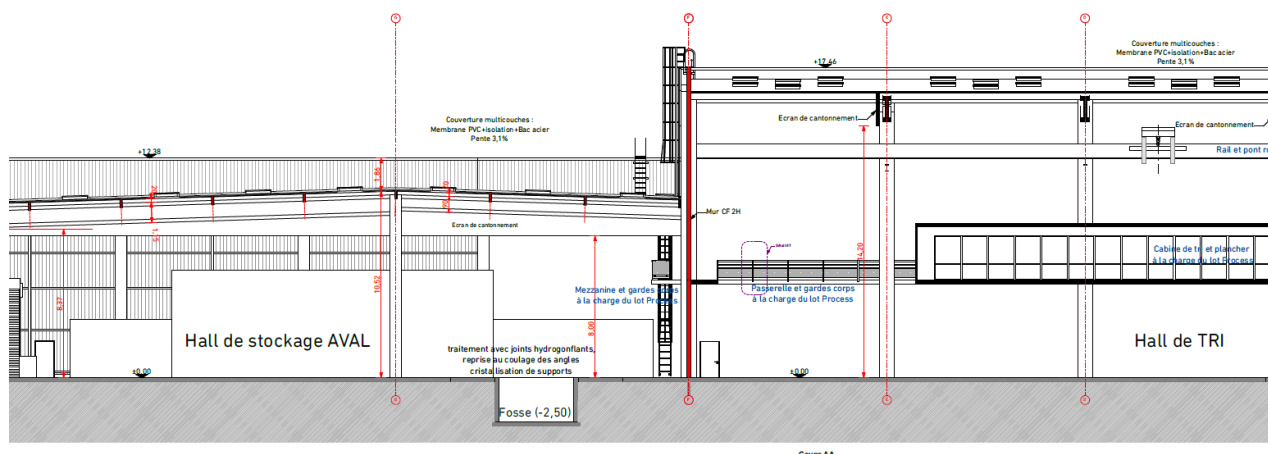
Vue en coupe séparation du hall aval et hall process par un mur REI 120 coupe-feu 2H en dépassement en toiture (source : Trinovia)
